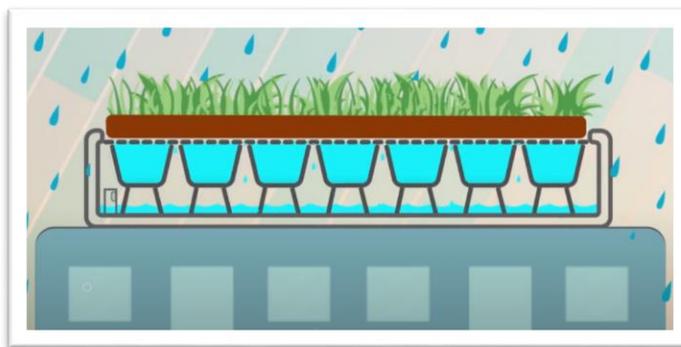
Sistema telhado verde, fonte: Ecotelhado
